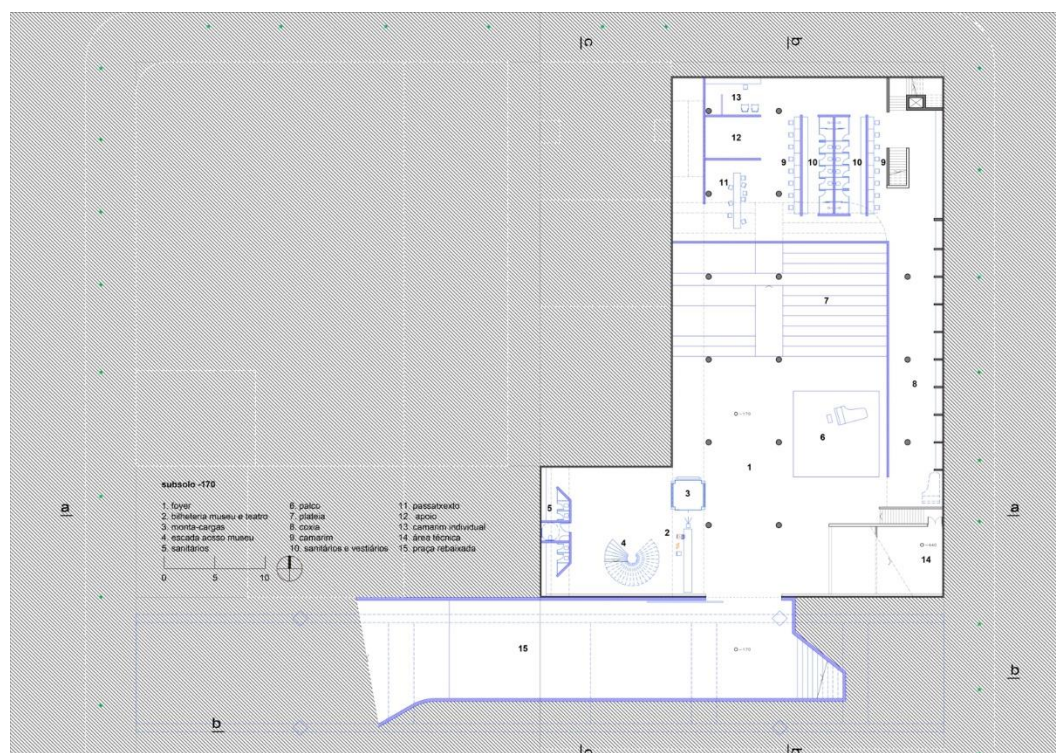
Planta do pavimento subsolo da intervenção na agência do Itaú.
